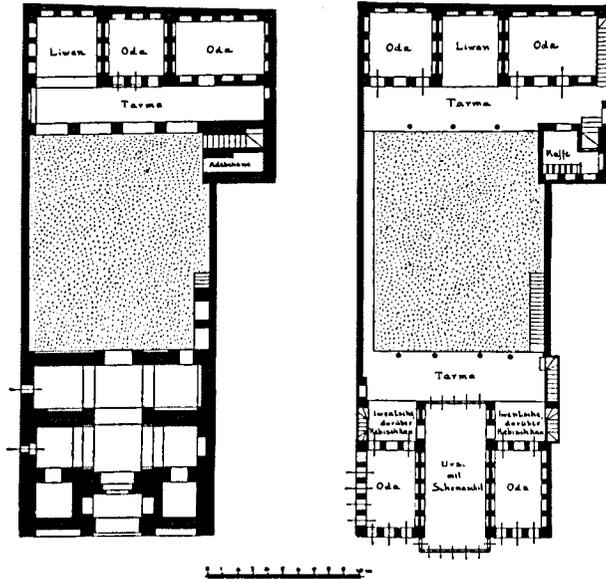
und 25. Haus des Hussein Beg in Hilleh. Grundrisse des Erd- und Obergeschosses.
